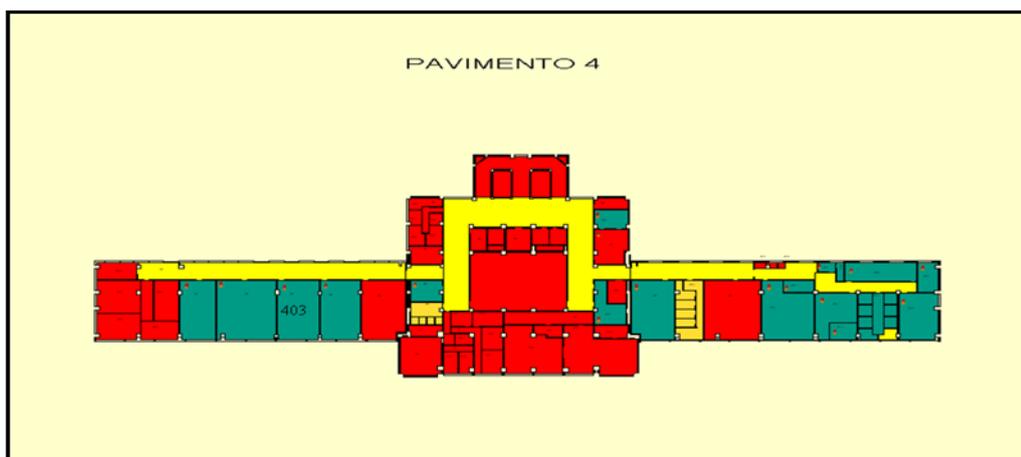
Planta baixa do 4º andar do Pavilhão Reitor Haroldo Lisboa da Cunha
